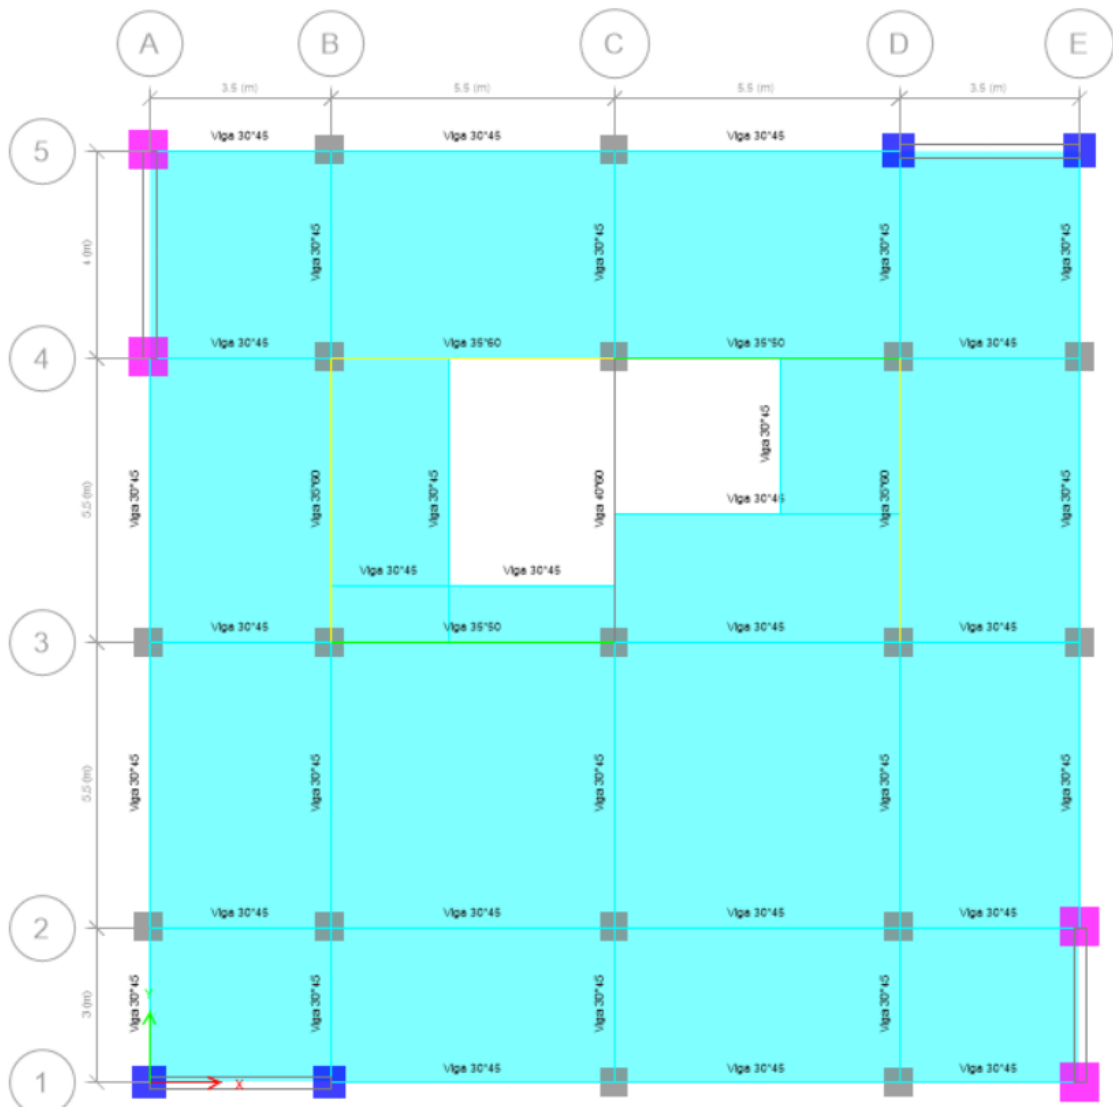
Planos estructurales del piso 1 definidos por ETABS bajo la norma E030
